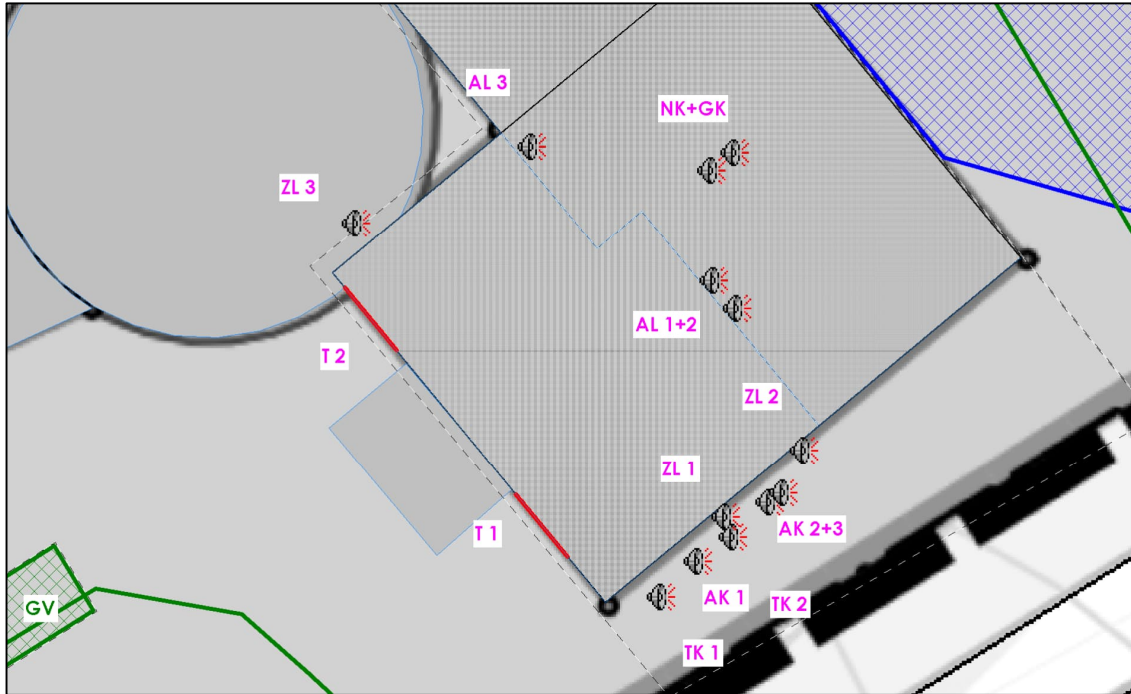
Lageplan mit Darstellung der stationären Schallquellen
